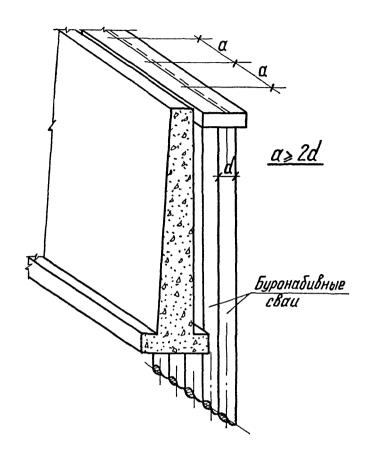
Усиление подпорных стен в стесненных условиях генплана с помощью буронабивных свай
